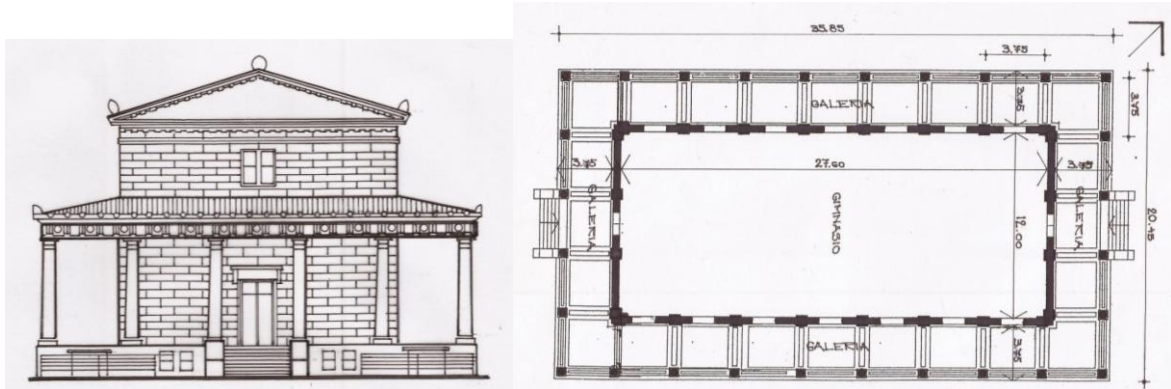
y 11: Vista frontal NE y planta. Dibujo rigorista. Uso de tinta.
